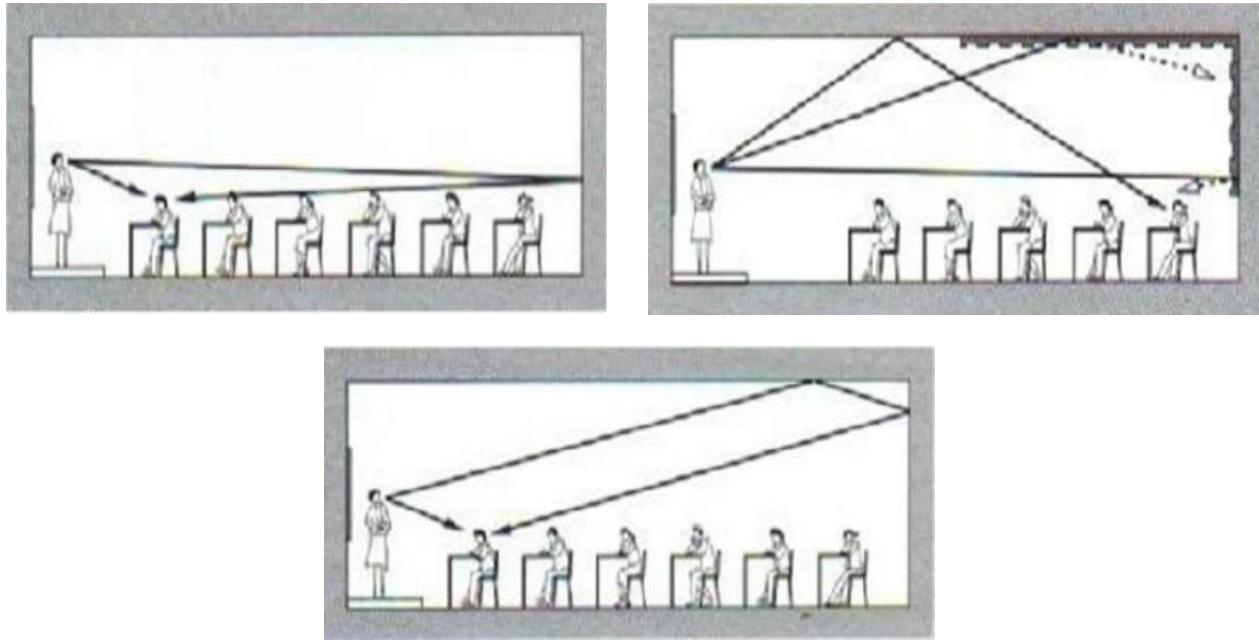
Traitement acoustique préconisé au niveau du plafond et du mur du fond de la salle. (Source : Hamayon, 2006)
